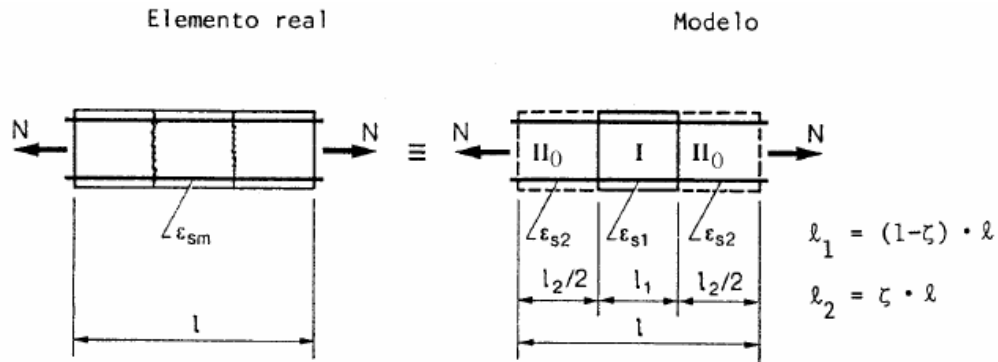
Modelo de cálculo para tração pura (Fonte:(Favre et al. 1985))
